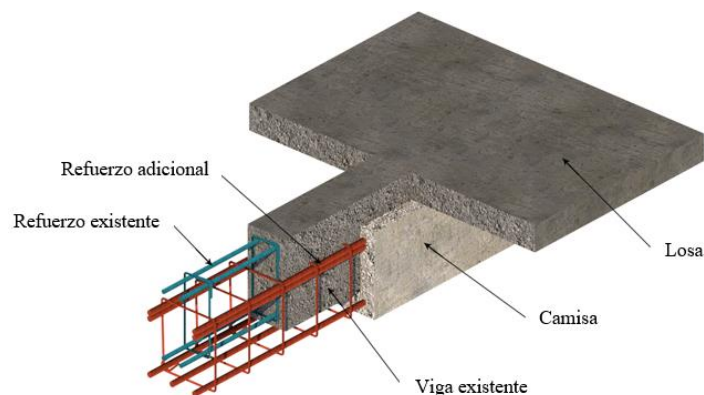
Ejemplo de viga con encamisado de concreto reforzado (INIFED, 2021)
